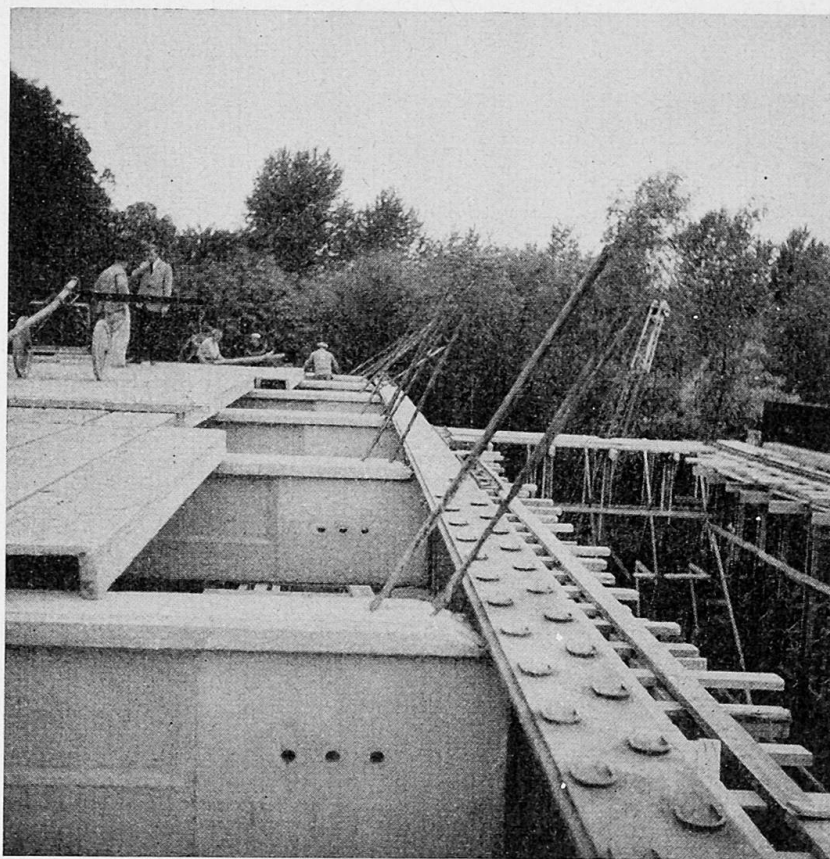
Nouveau Musée de l'Afrique Centrale à Tervueren*. Poutres Préflex de 25 m de portée supportant les poutres secondaires en béton précontraint de 8,40 m distantes de 4,20 m. Le hourdis est composé d'éléments préfabriqués en béton précontraint. A noter, les barres de continuité des poutres secondaires qui sont repliées au-dessus des poutres Préflex.
